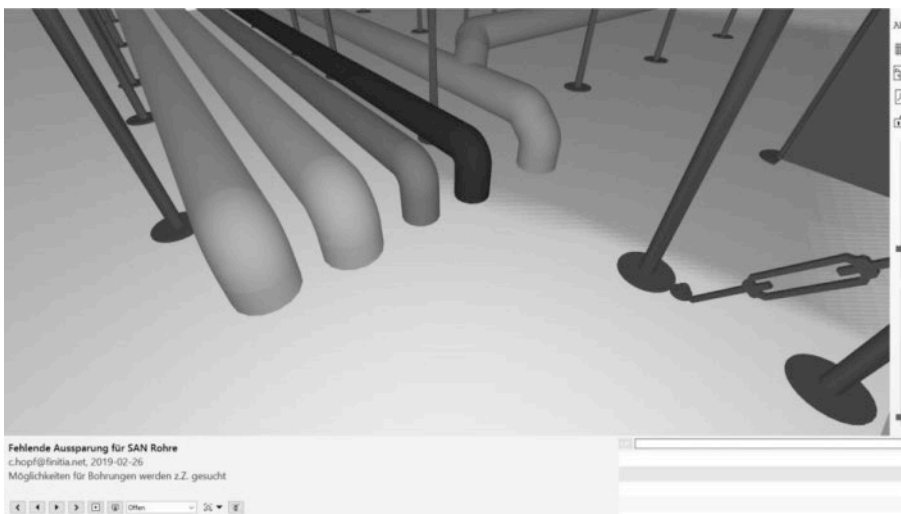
Kollision mehrerer Rohre mit Geschosdecke
